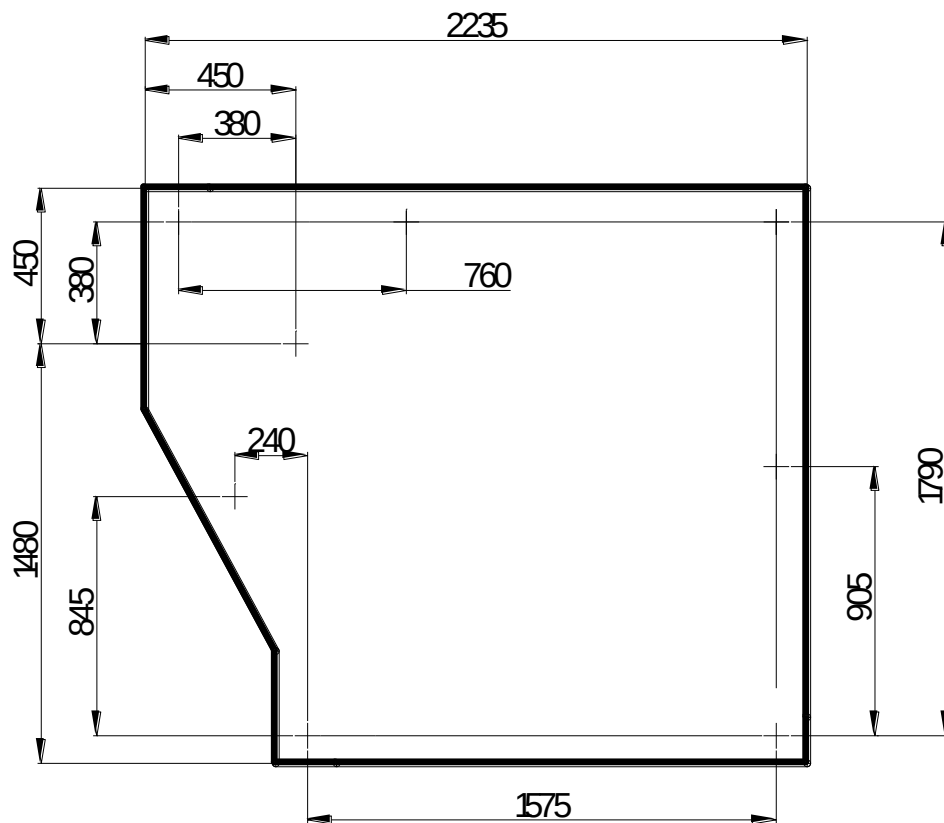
2. План фундаменту під автомат ВМБ 40 / 12
